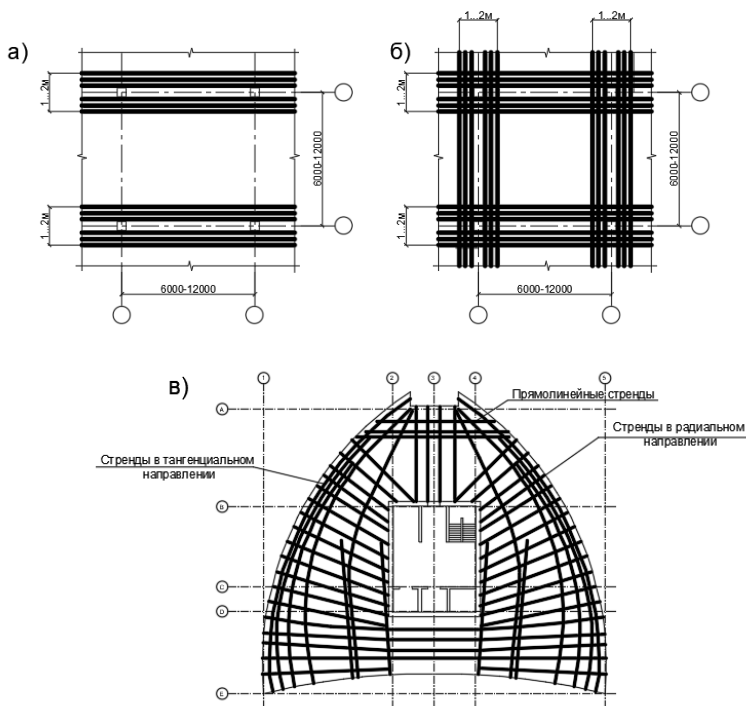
Схемы армирования постнатяжёнными элементами [2]:
